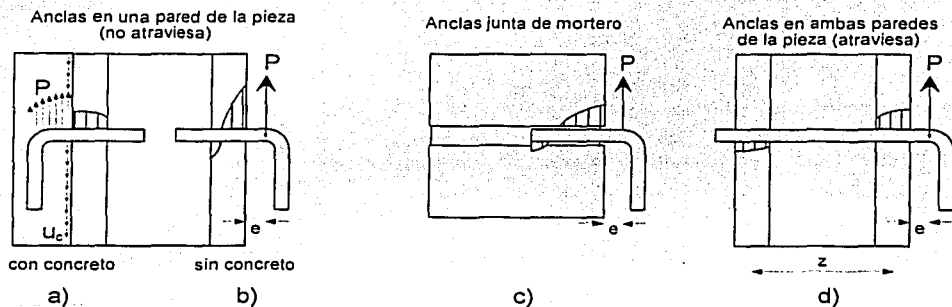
Esfuerzos de compresión en la pieza de mampostería
